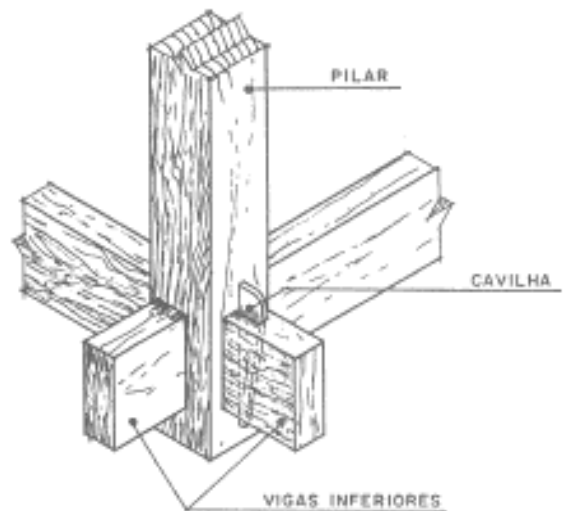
Detalhe de encaixe do pilar com as vigas inferiores
